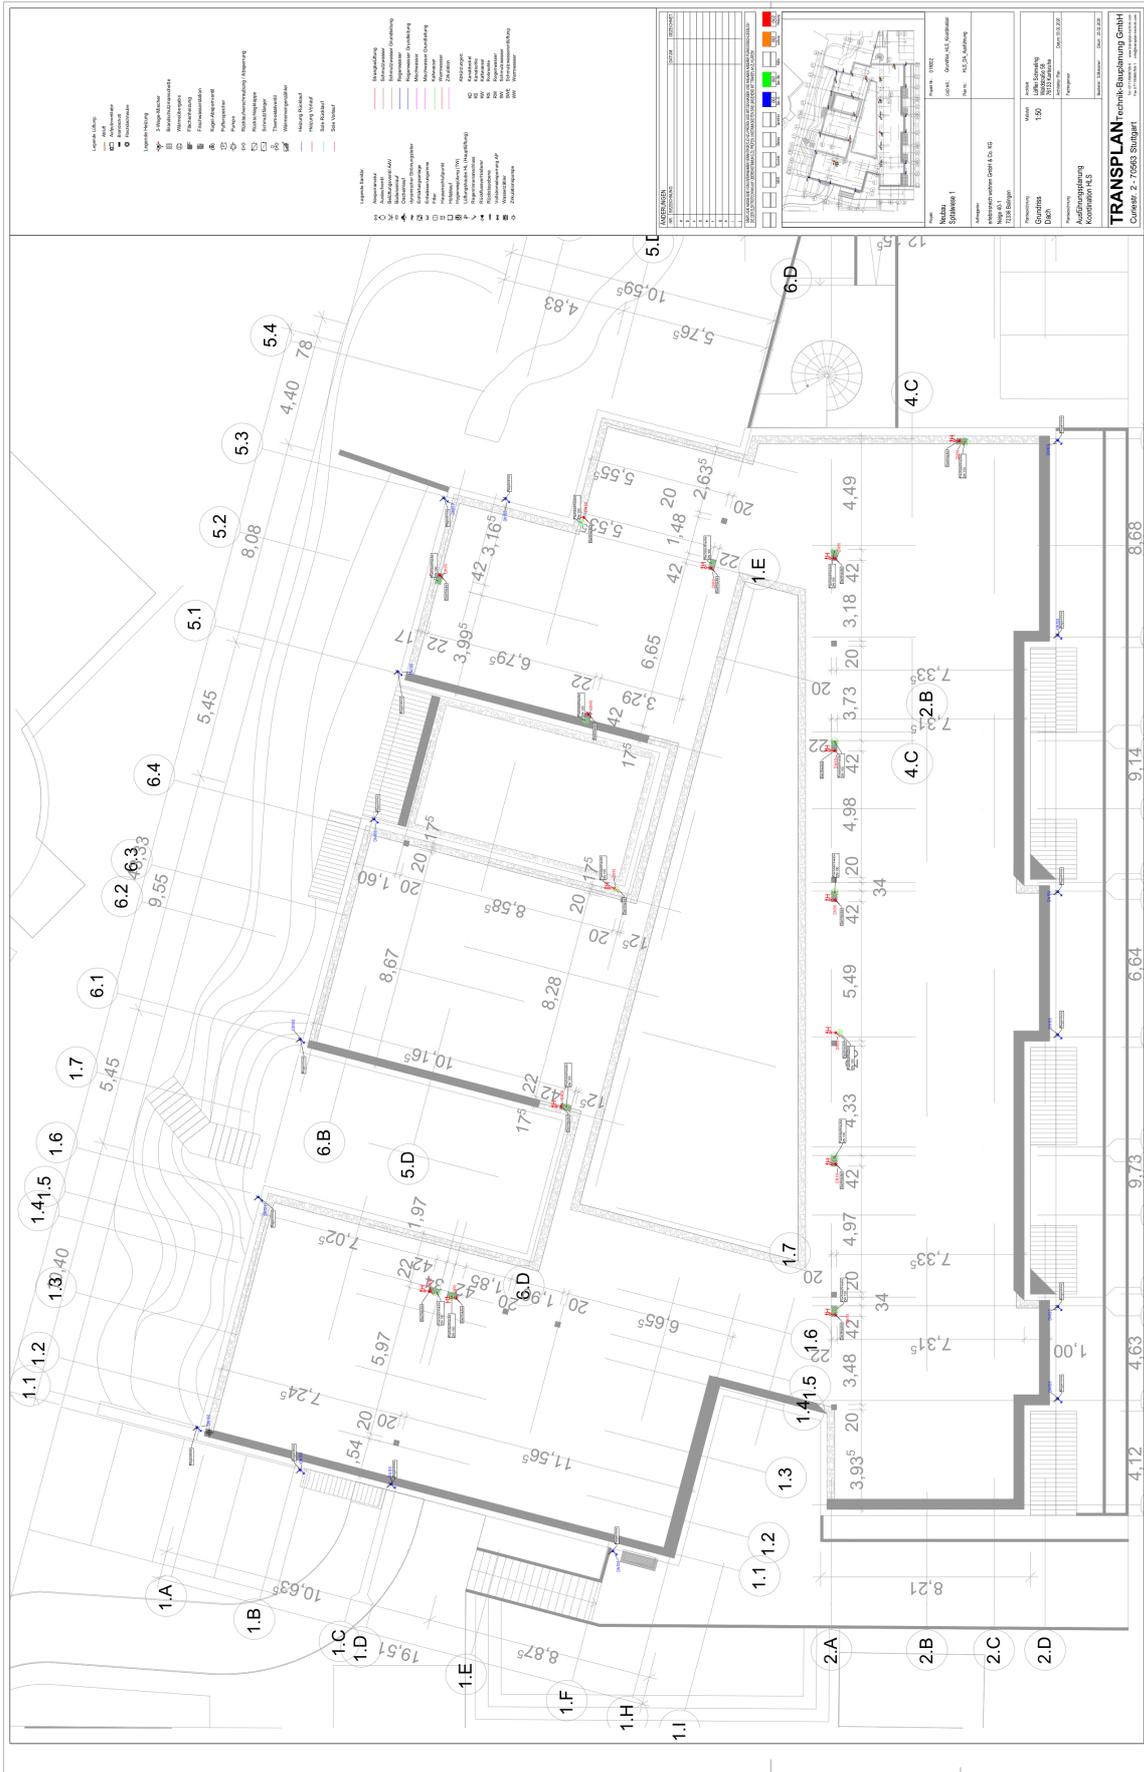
Anlage - HLS Planung, Grundriss, Dach
